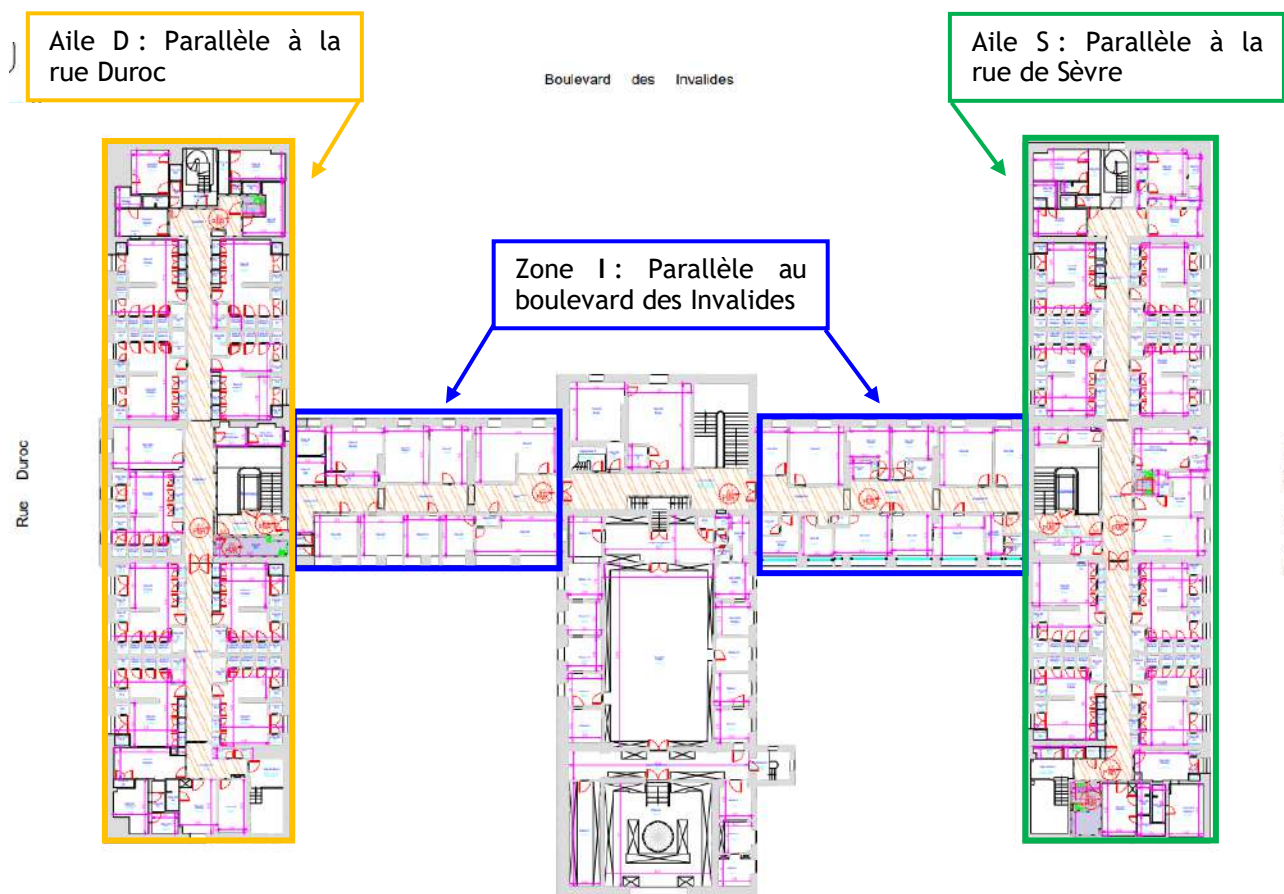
Nomenclature des zones sur fond de plan géomètre R+3
